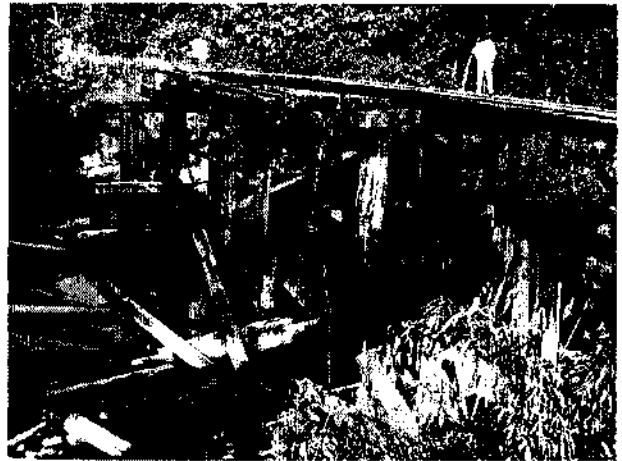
grande parte das pontes de madeira foi construída e reconstruída diversas vezes.
